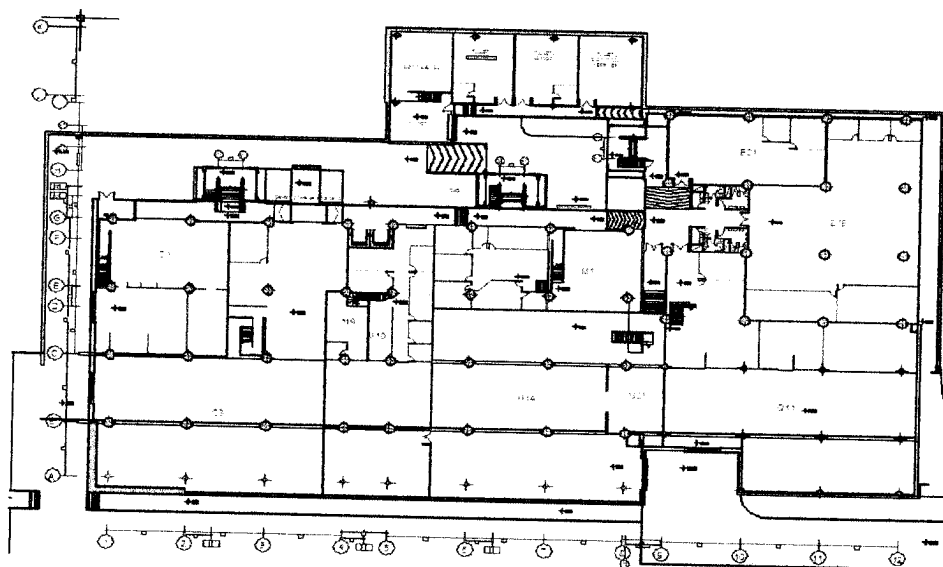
, Detalle de ejes “grid” en planta sótano arquitectura original.
